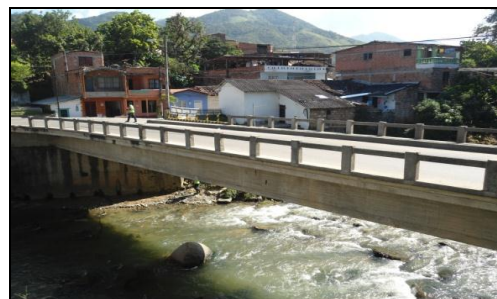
VISTA PANORAMICA TRANSVERSAL
